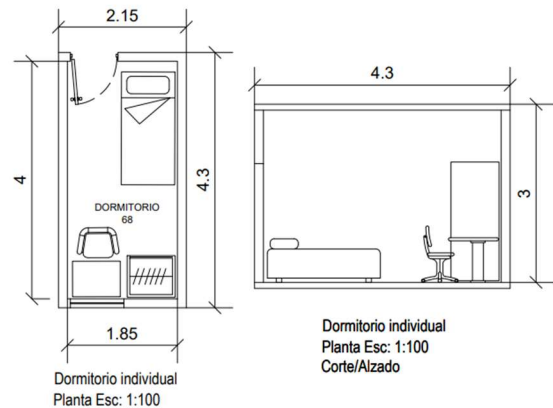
Planta y alzado de dormitorio individual esc: 1:100
